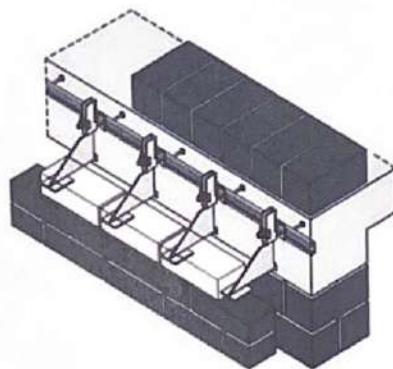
Вариант конструкции наружной стены с опиранием лицевого слоя на стальные кронштейны [1.22]
